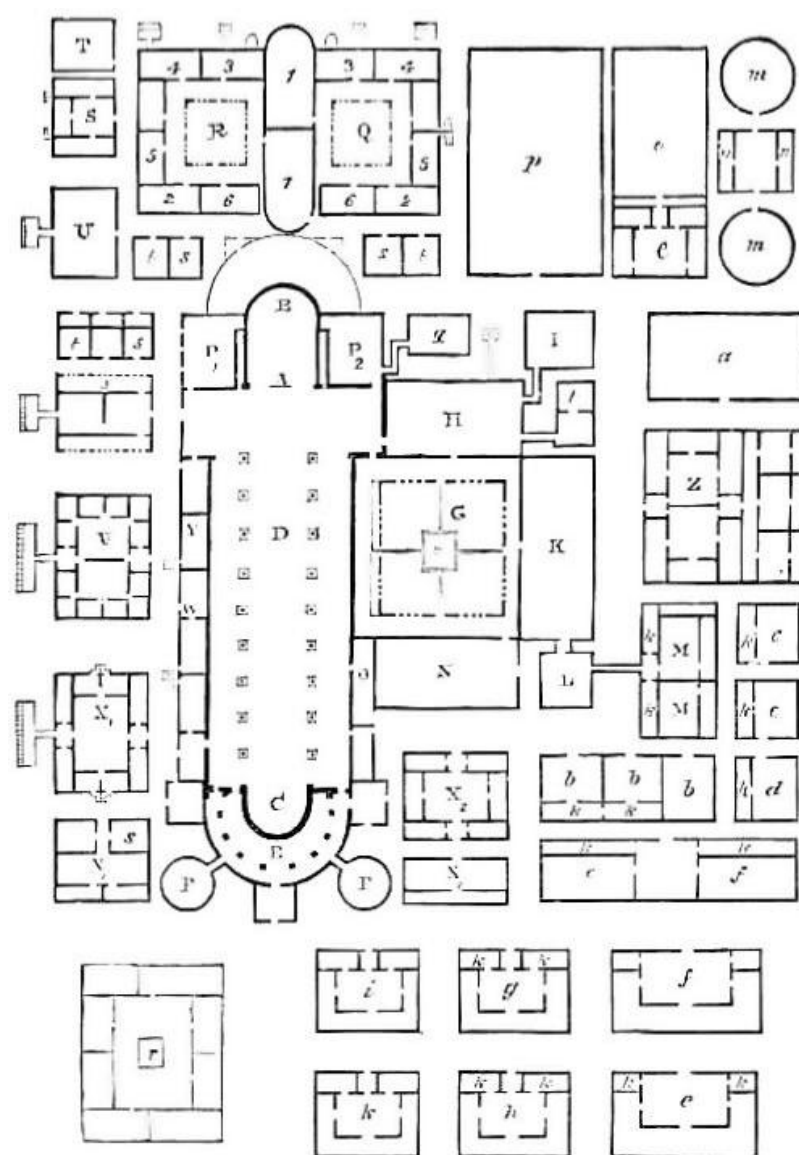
Plano de planta del monasterio de Saint Gallen, Suiza.
